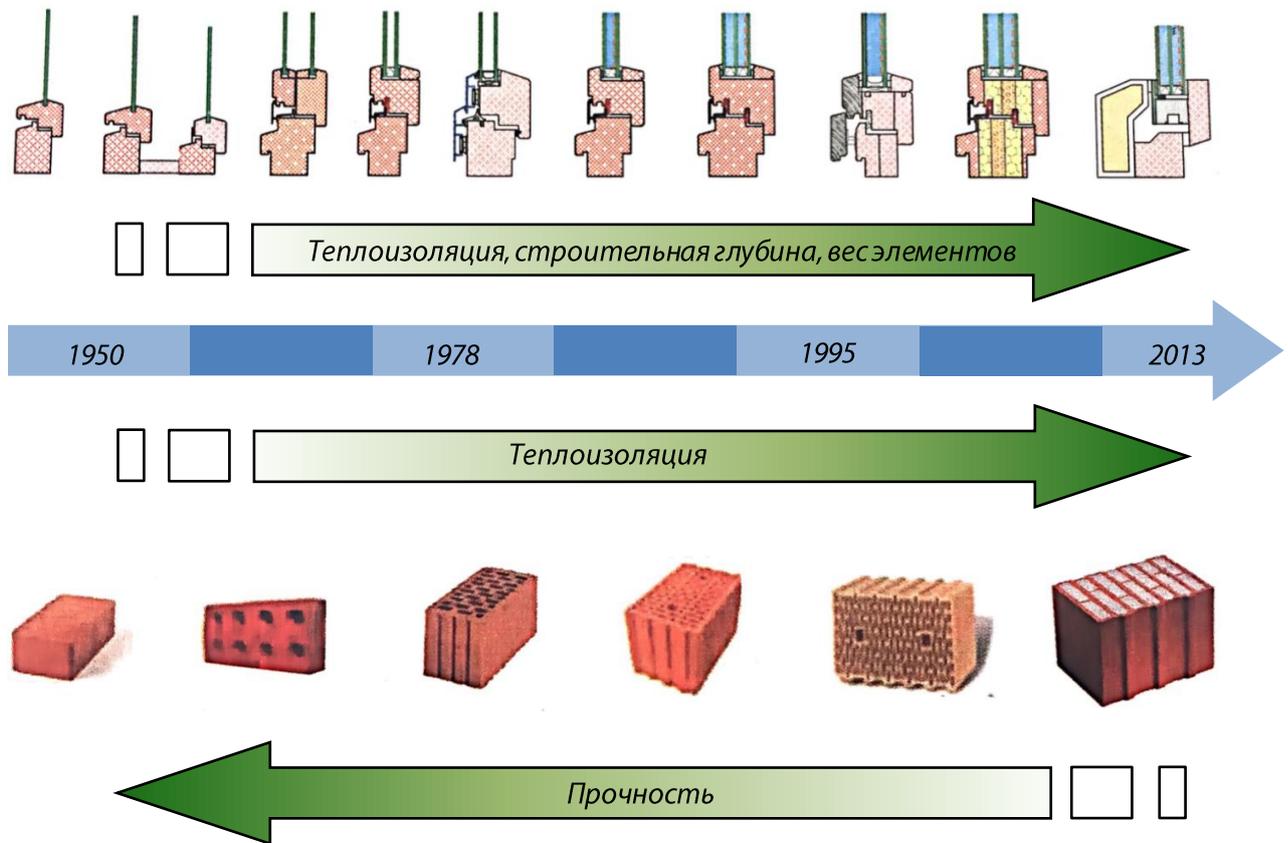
Развитие на примере деревянных и деревокомпозитных конструкций и систем наружных стен из кирпича.
